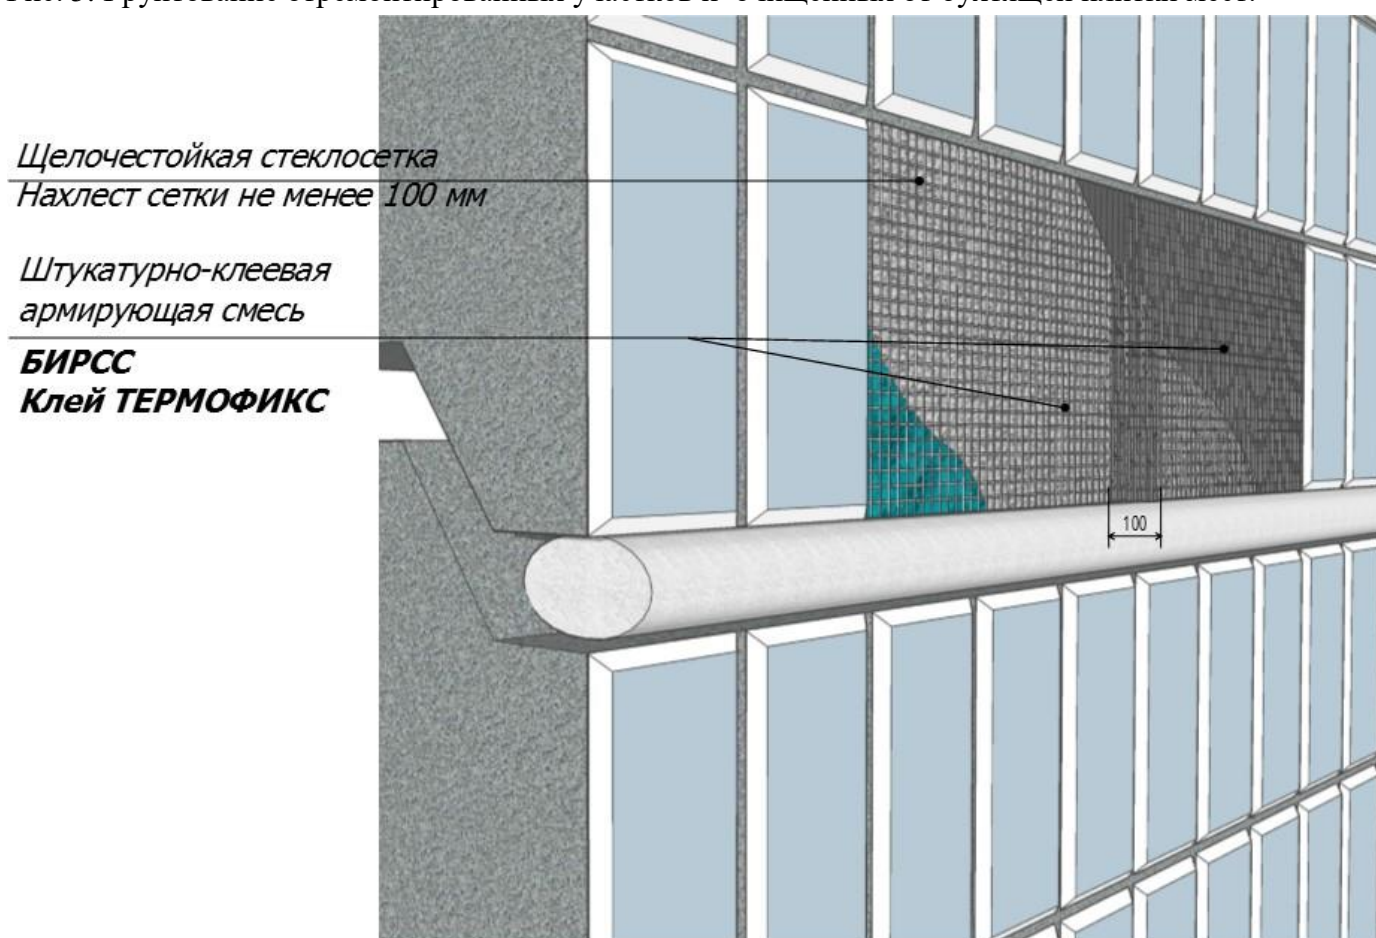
Создание штукатурно-армирующего слоя в местах удаленной плитки с армированием щелочестойкой фасадной сеткой
